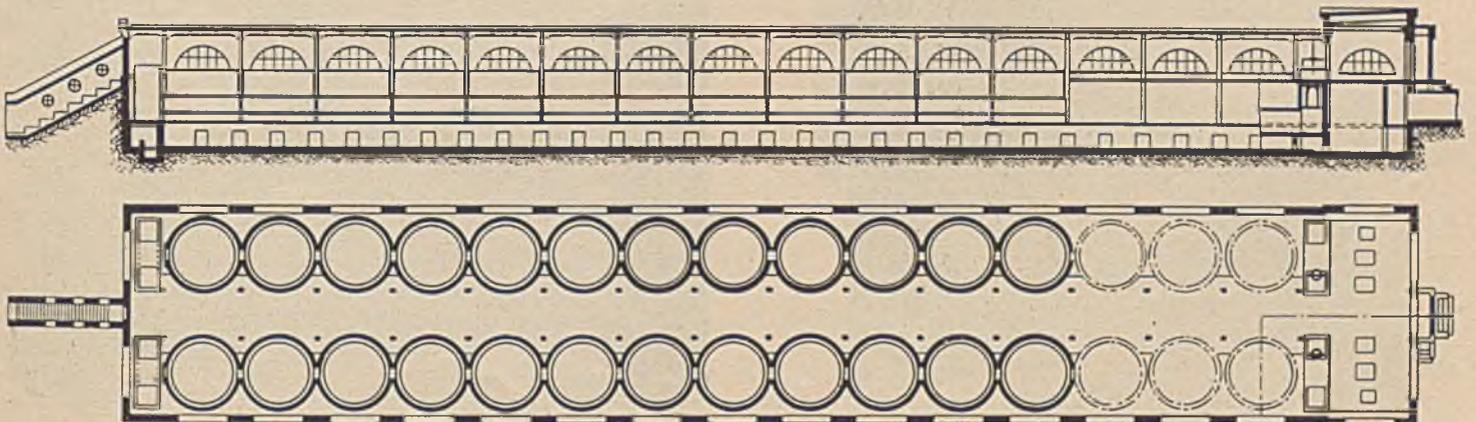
Filterwerk der Kaukas-Fabrik in Willmanstrand. Ausführung: A. B. Järn- und Betonbau. Gesamtentwurf: Ing. O. Weyerstall.
